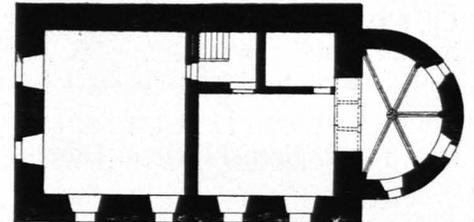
St. Pankrazkapelle bei Wurmbrand, Grundriß 1 : 300 (S. 296)
